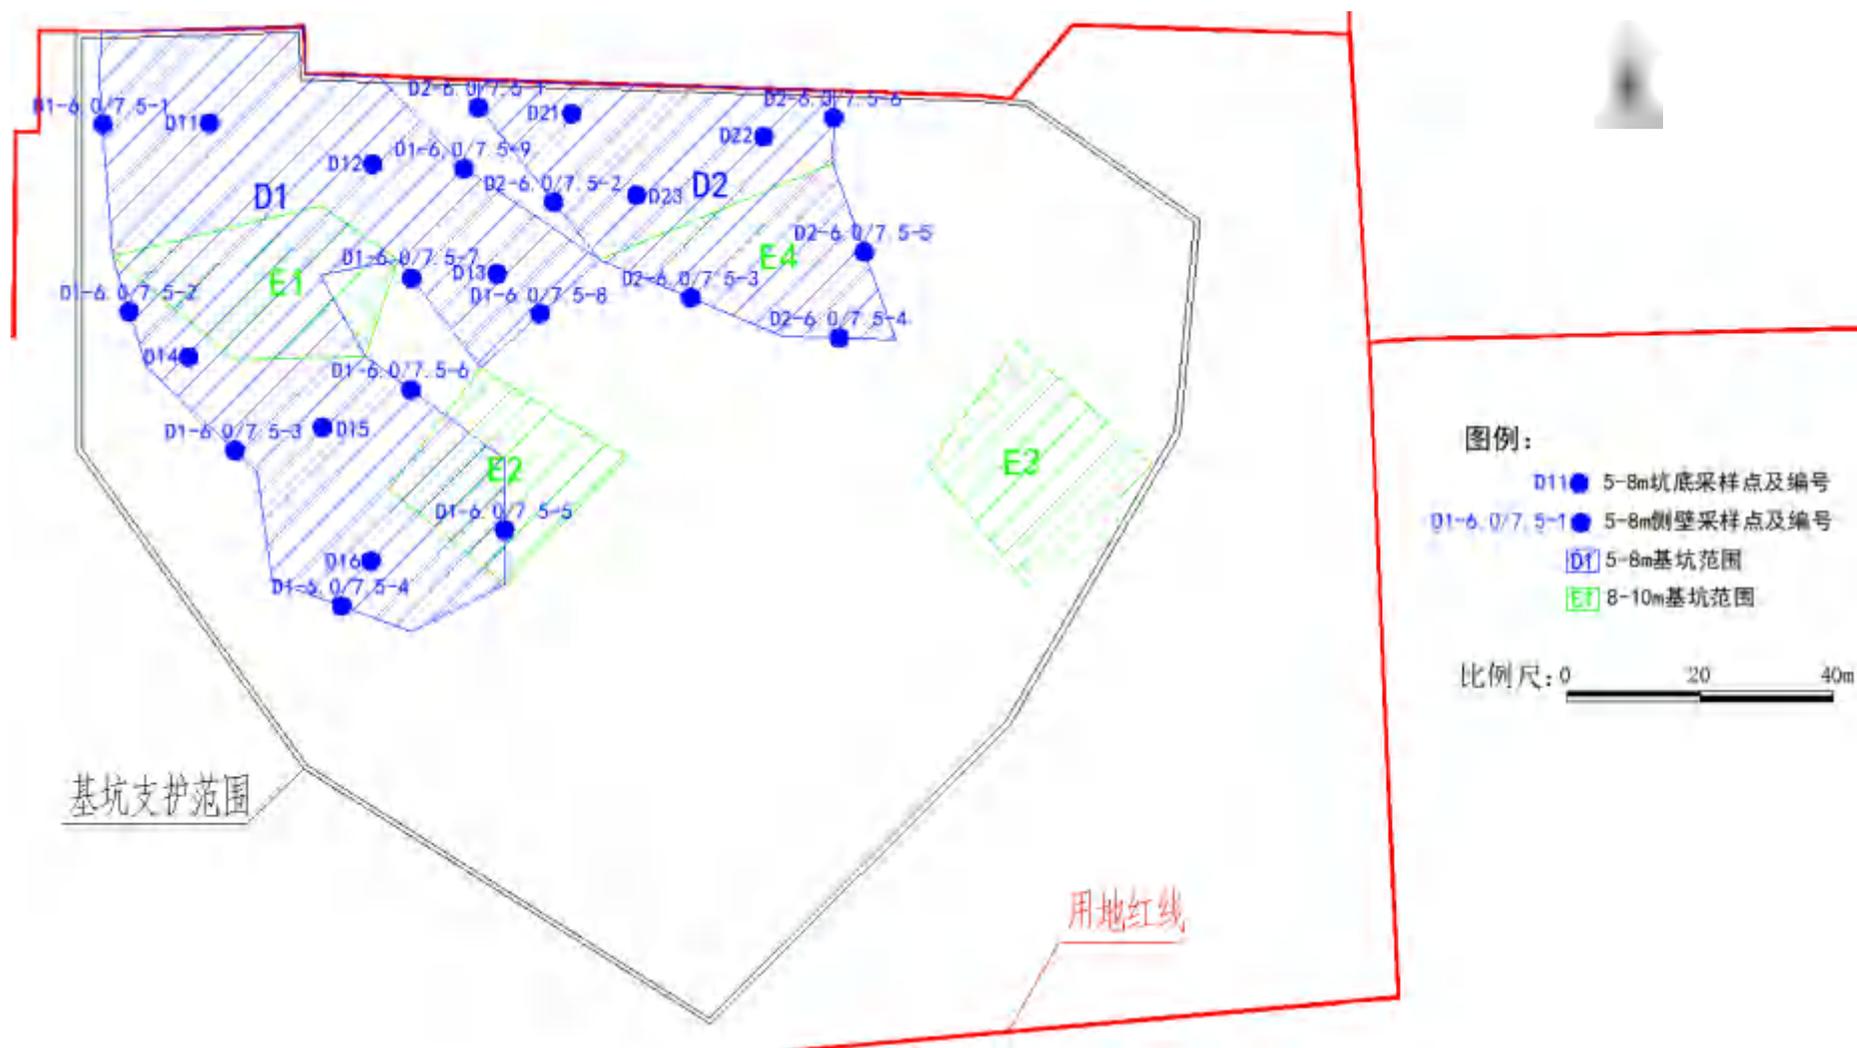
基坑侧壁和底部采样点平面布置图（5-8m）
